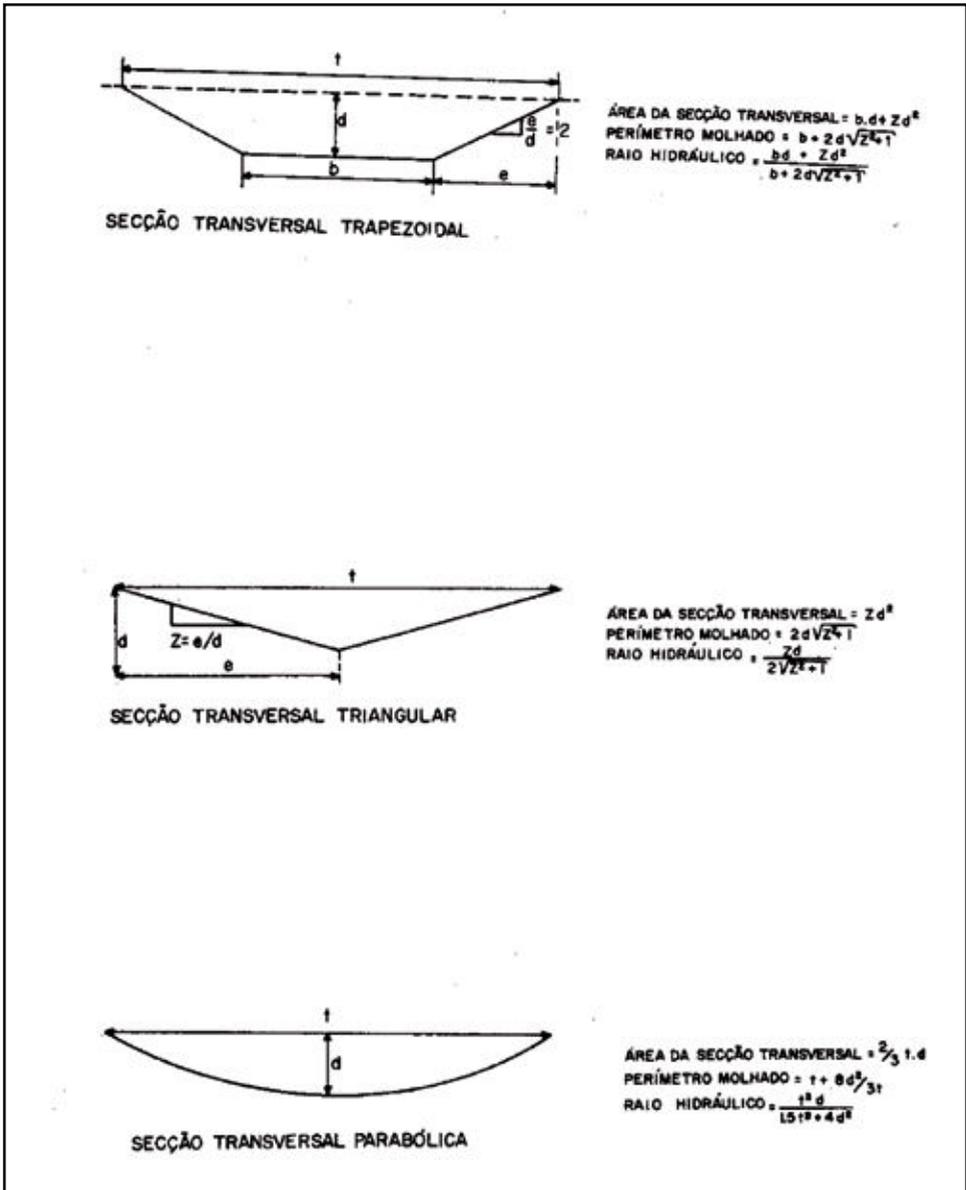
Seções Trapezoidal, Triangular e Parabólica de Canais Escadouros.
